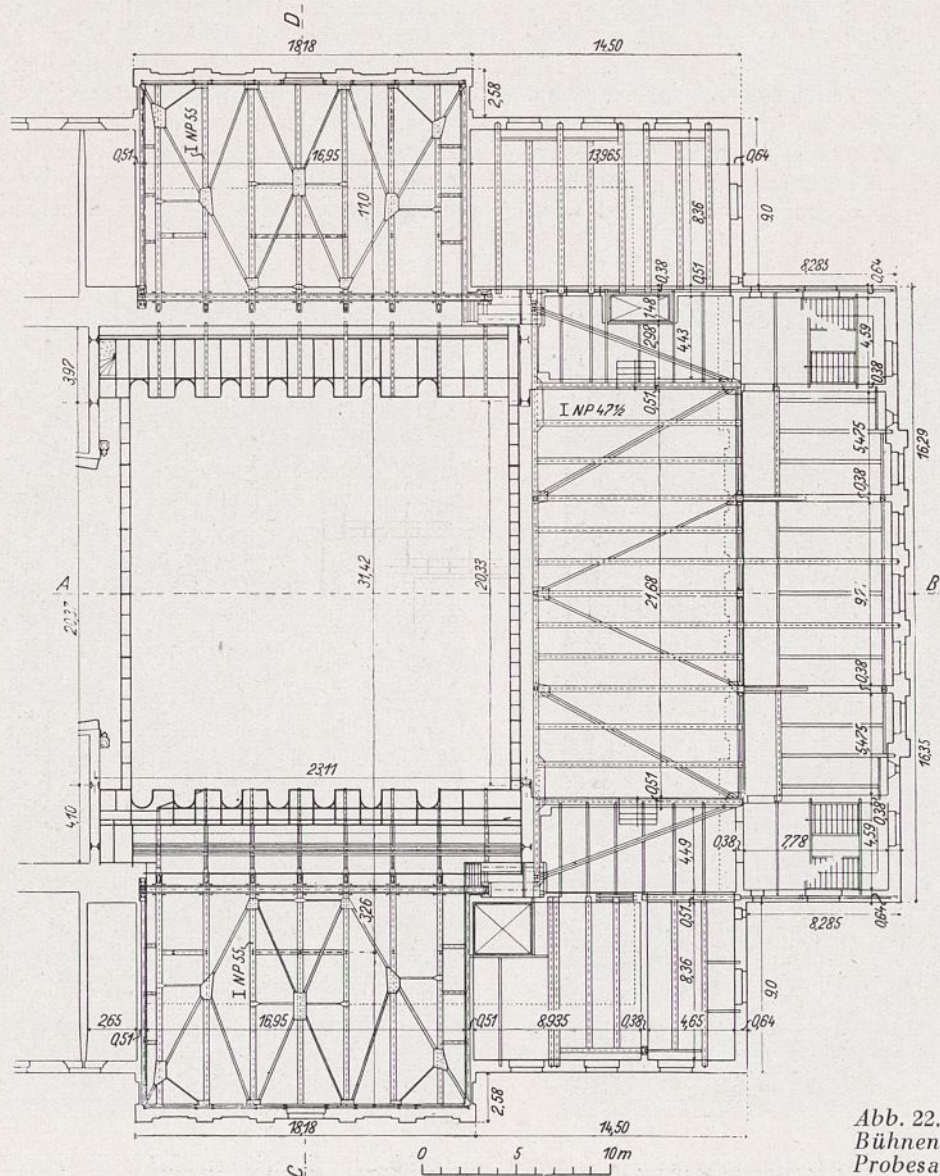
Eisenkonstruktion des Bühnenhauses. Grundriß des Probesaalgeschosses.
